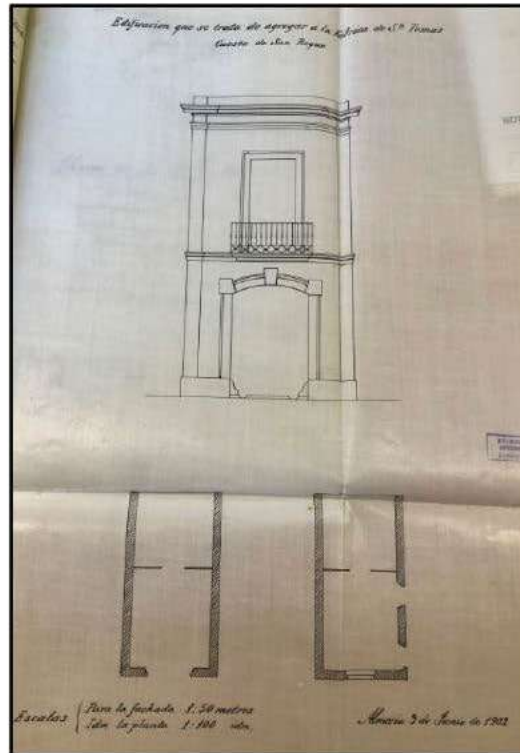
Alzado y planta de la petición de José Cañadas para añadir una edificación a la Fundación Santo Tomás, 1902. Fuente: AMA, Signatura 1-2-7-6-C-478-58
